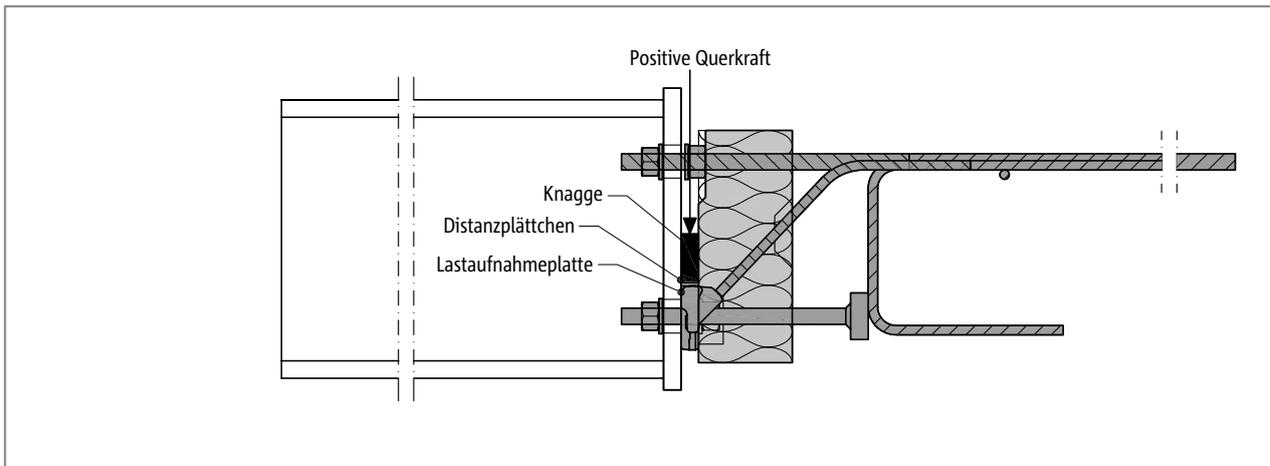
Schöck Isokorb® T Typ SK: Bauseitige Knagge zur Übertragung der Querkraft
